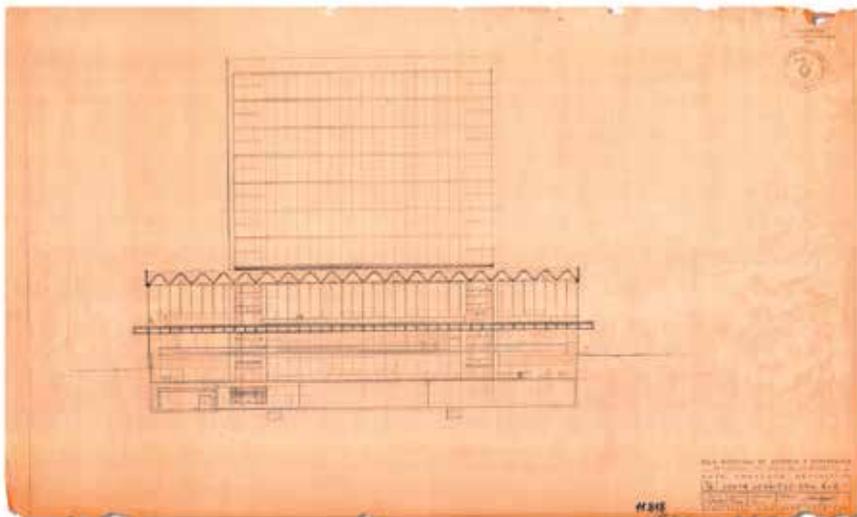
AROZTEGUI, CNAD (ANTEPROYECTO, 1957). CORTE LONGITUDINAL. SE PUEDE APRECIAR LA SOLUCIÓN DADA A LA CUBIERTA POR EL ARQUITECTO. CDI-IHA, PL. 11818.
